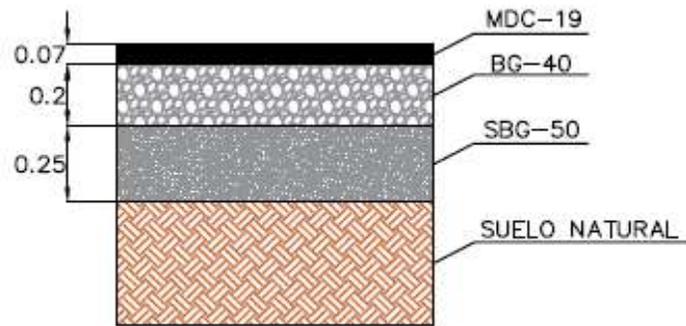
Perfil diseño estructura de pavimento Villa Helena I.
